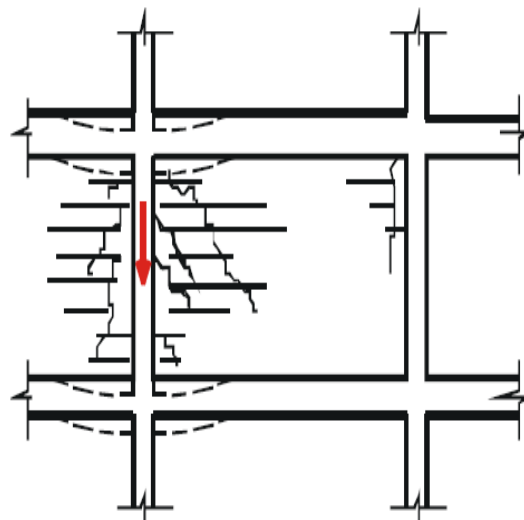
Fissuras verticais junto ao solo por ruptura de fundações
